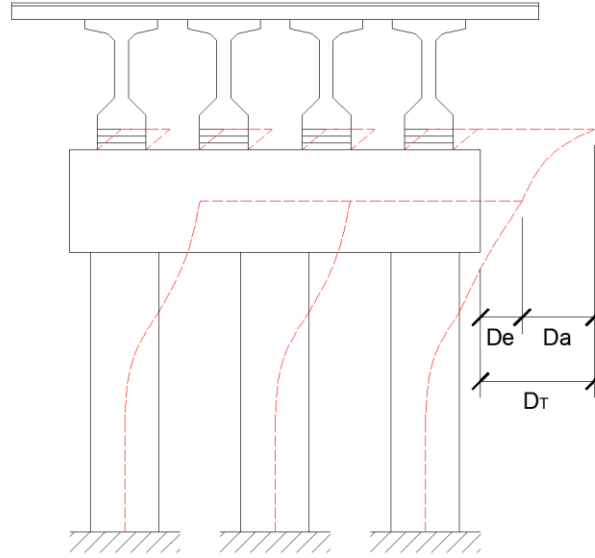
Desplazamiento en la estructura del puente aislado.
